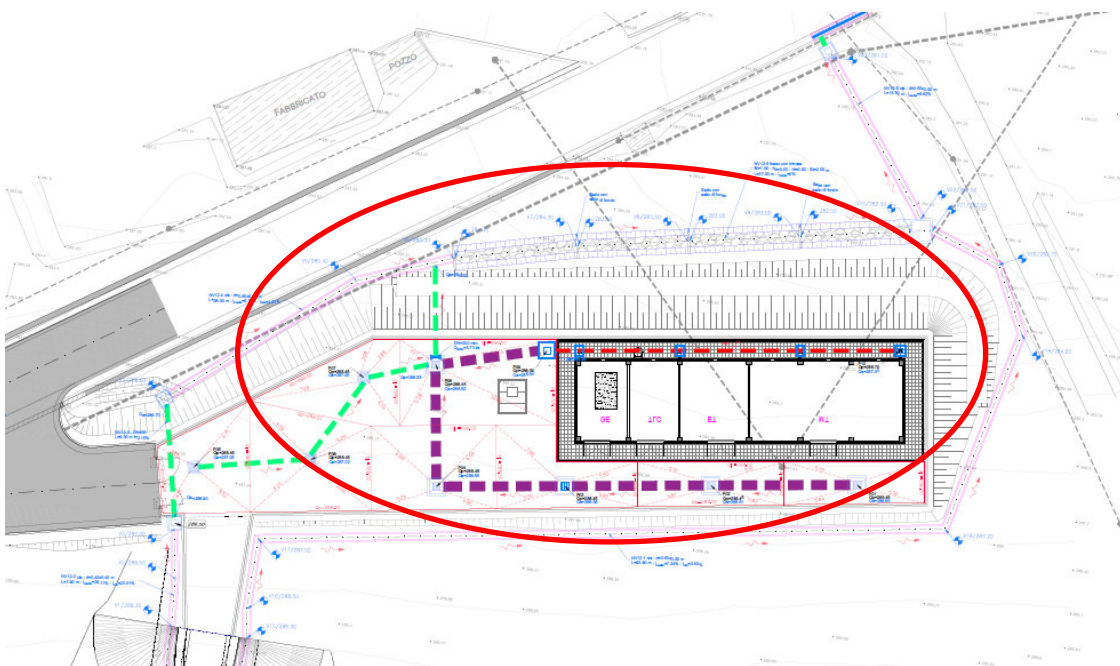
Planimetria della sistemazione del piazzale RI58 come da prescrizione in oggetto
